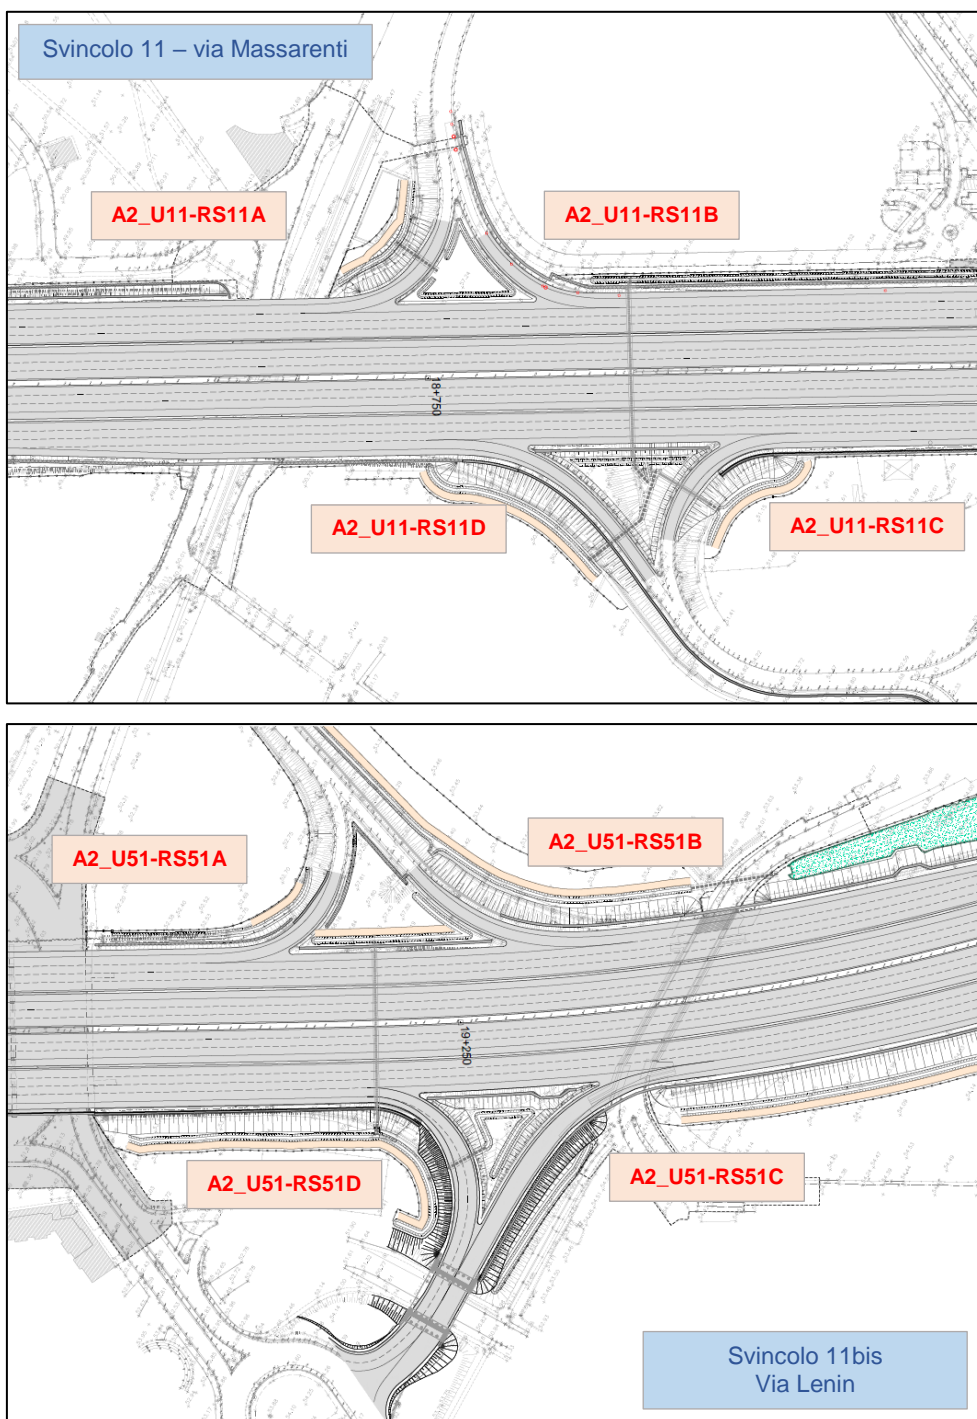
Stralcio planimetrico svincolo n. 11 e 11bis
